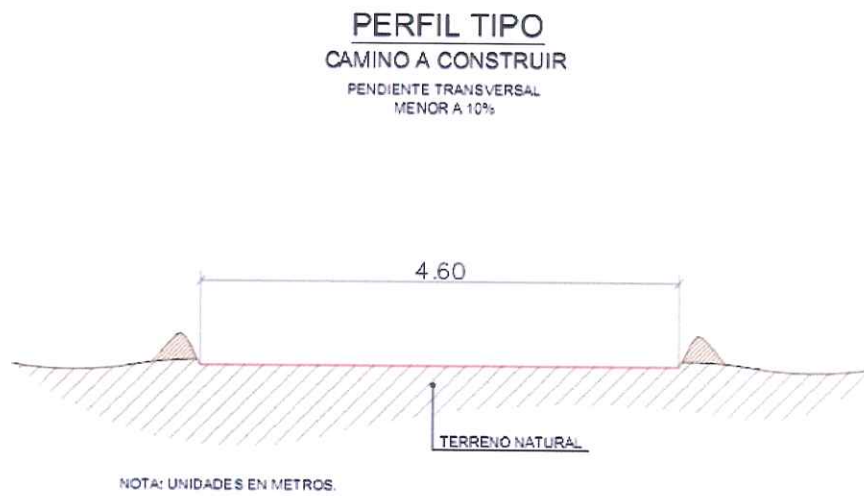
Perfil Tipo Camino a Construir pendiente transversal menor a 30%
